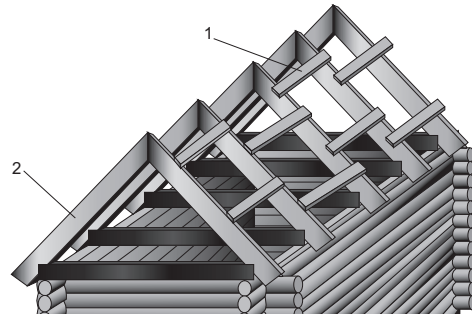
Временная фиксация стропил: 1 — доски; 2 — стропильная ферма
